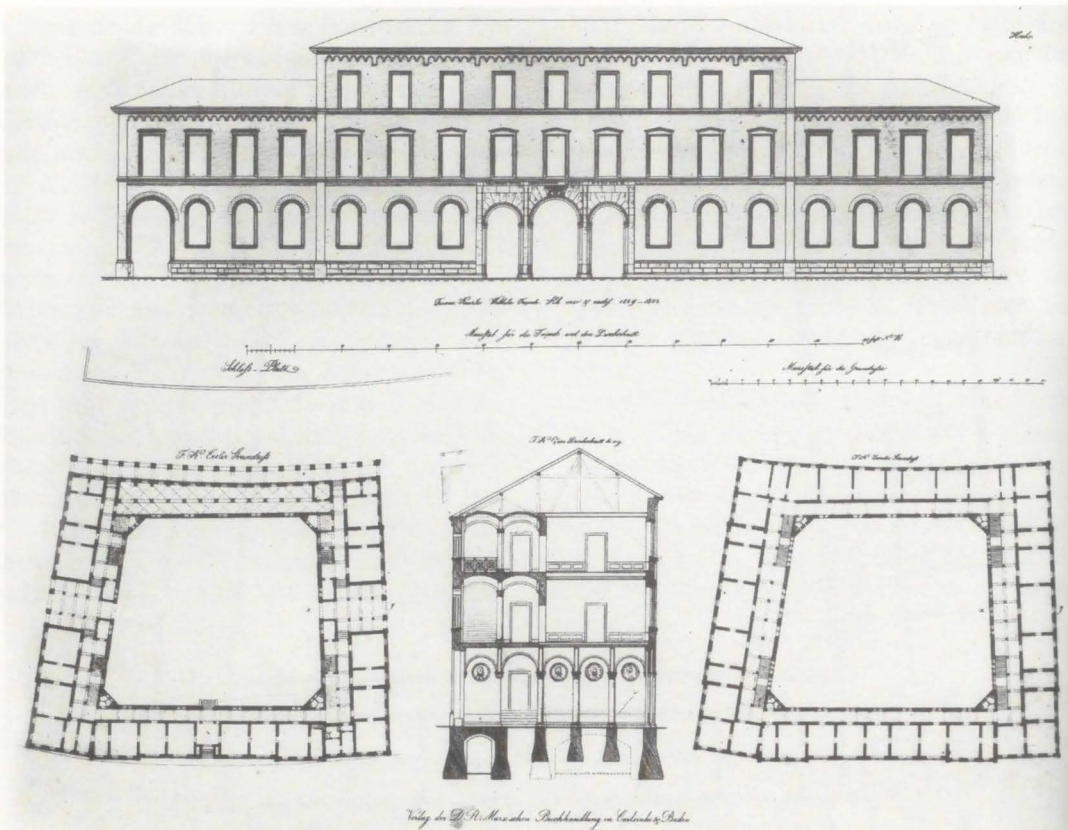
Finanz-Kanzlei; Westliche Facade, Erster Grundriss, Durchschnitt, Zweiter Grundriss. Aus dem Tafelteil der „Bauwerke“ 1838.
